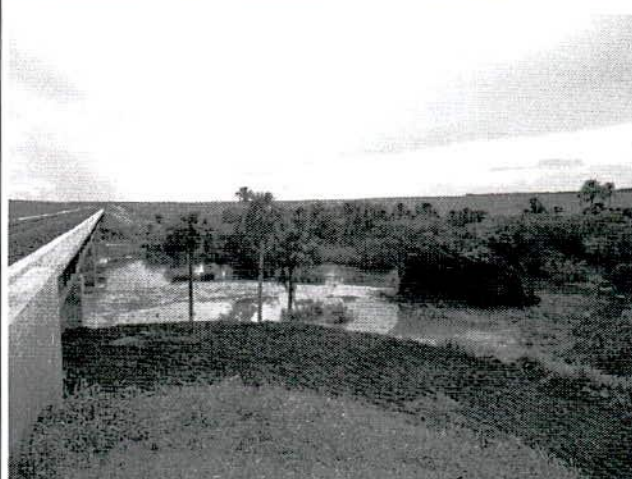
OAE Riacho Ponte de Pedra 3 necessitando de reforço na hidrossemeadura.
